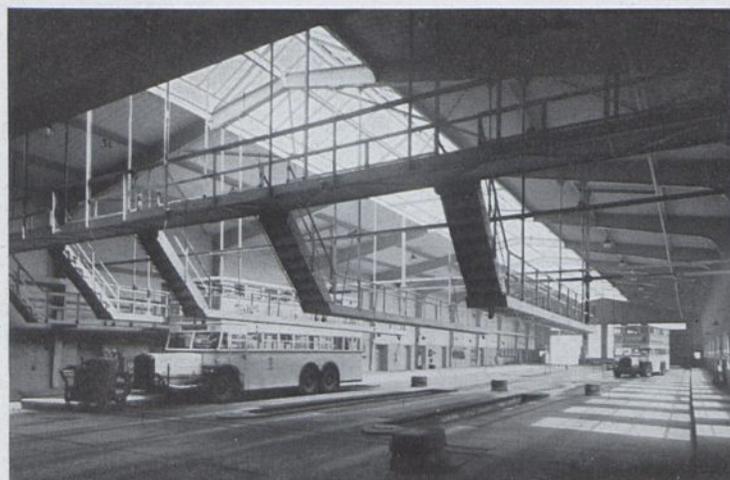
Halle I. Blick auf die Putzgerüste und die Revisionsstände.
